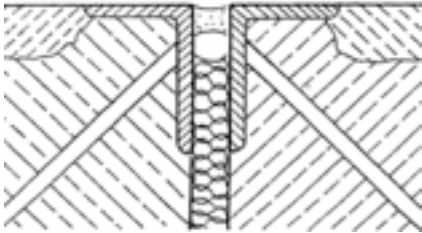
Anzustrebende Konstruktion einer Bewegungsfuge für schwere Beanspruchung. Verankerung im Beton
